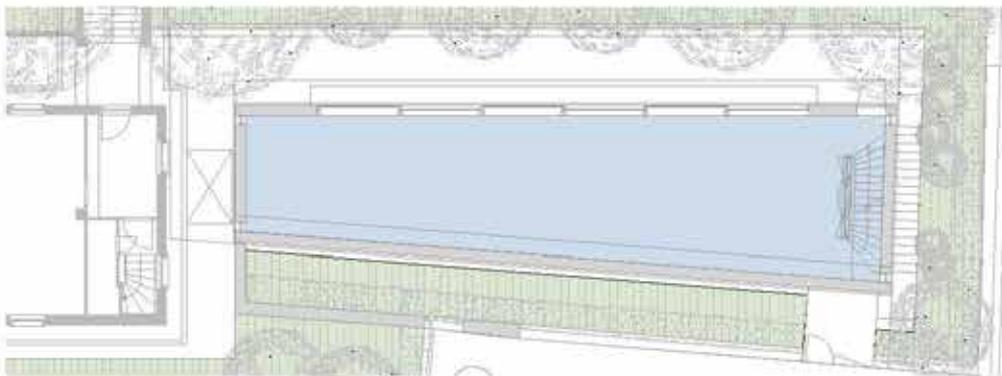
Anrechenbare Geschossfläche Erdgeschoss
